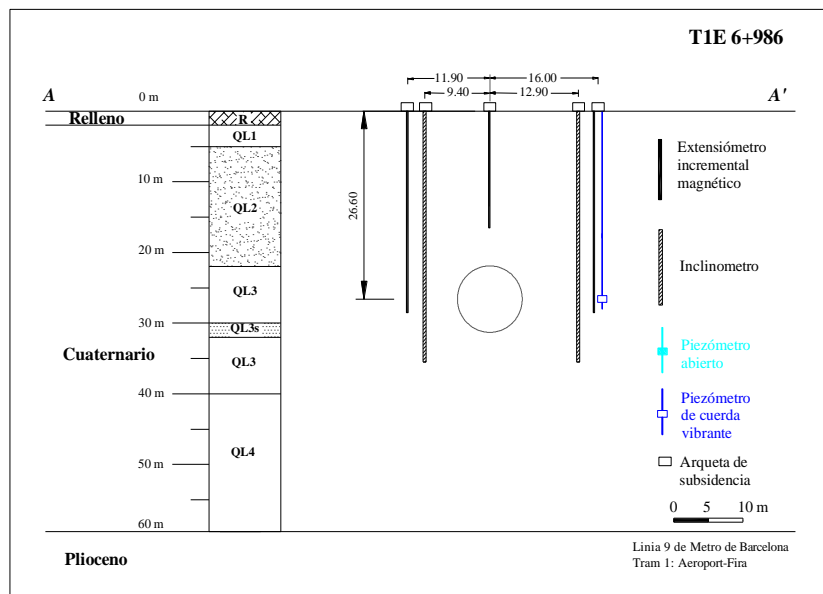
39. Perfil de la instrumentación instalada en la sección de control T1E PK 6+986
